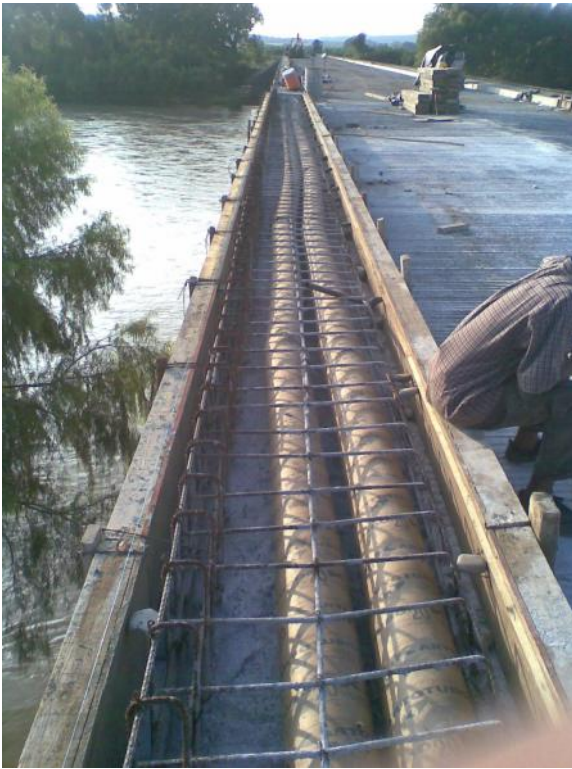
y 142 Cimbrada una banqueta y el colado de otra escobillada y con pendiente hacia la calzada.
